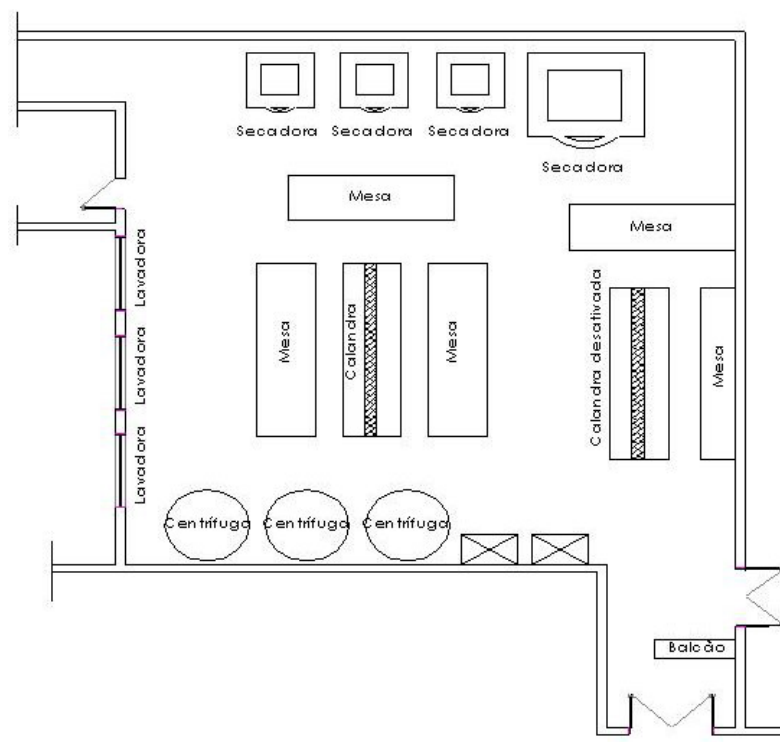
LAYOUT DA ÁREA LIMPA DA LAVANDERIA (SEM ESCALA)
